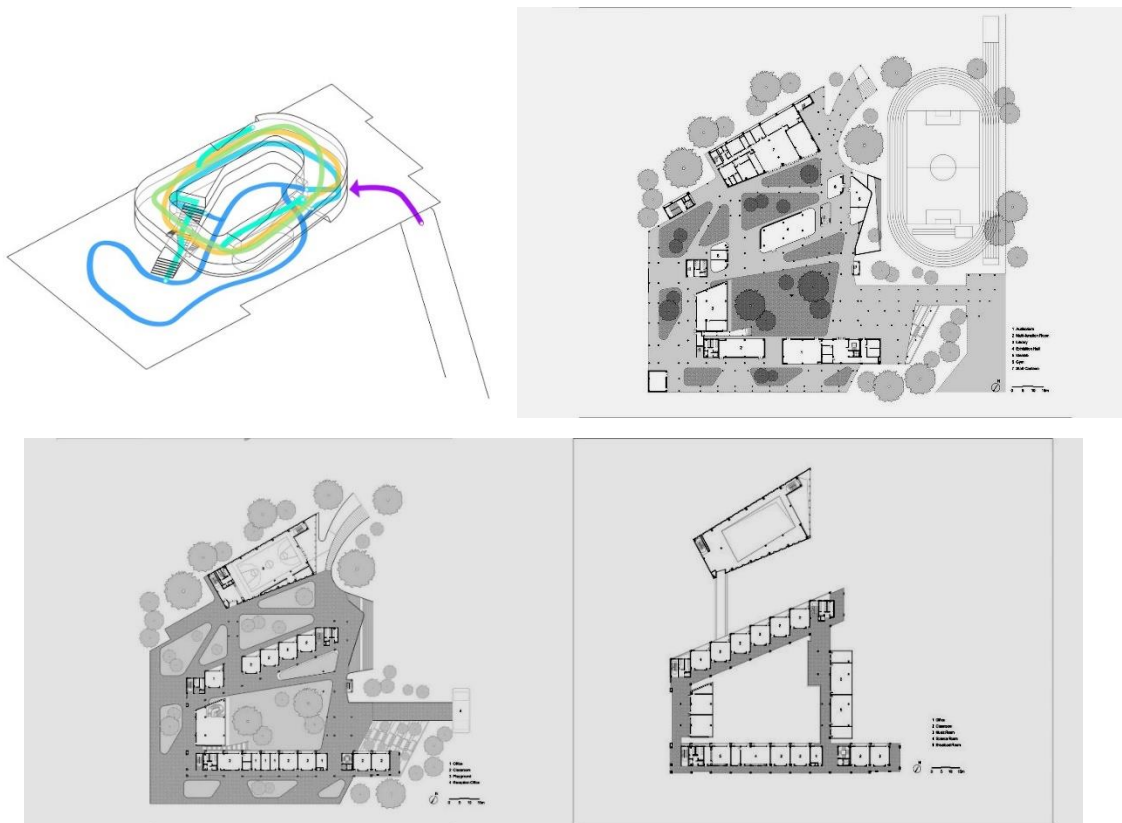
Схема планувань та схема функціонального зв'язку [10]
